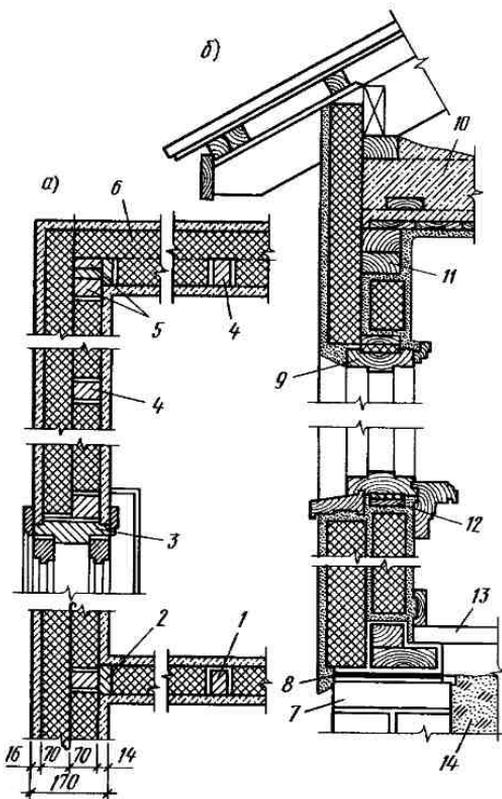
Детали конструкций каркасного дома с утеплением стен фибролитовыми плитами:
